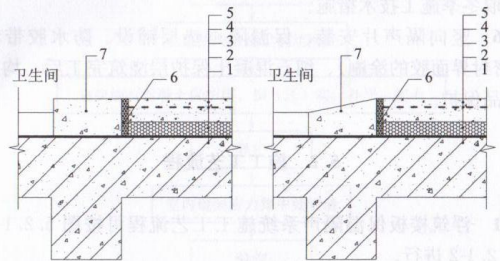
浮筑楼板与卫生间地面交接处构造 (剖面图)
